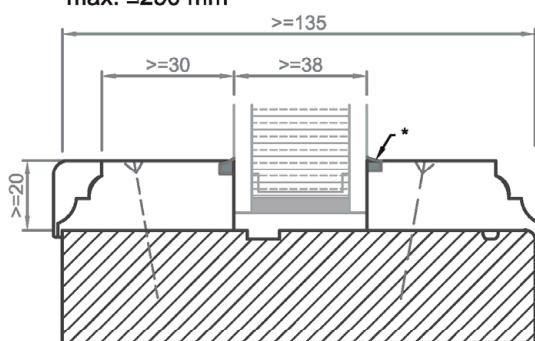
Senkkopf-Holzschraube mit Silikontasche
